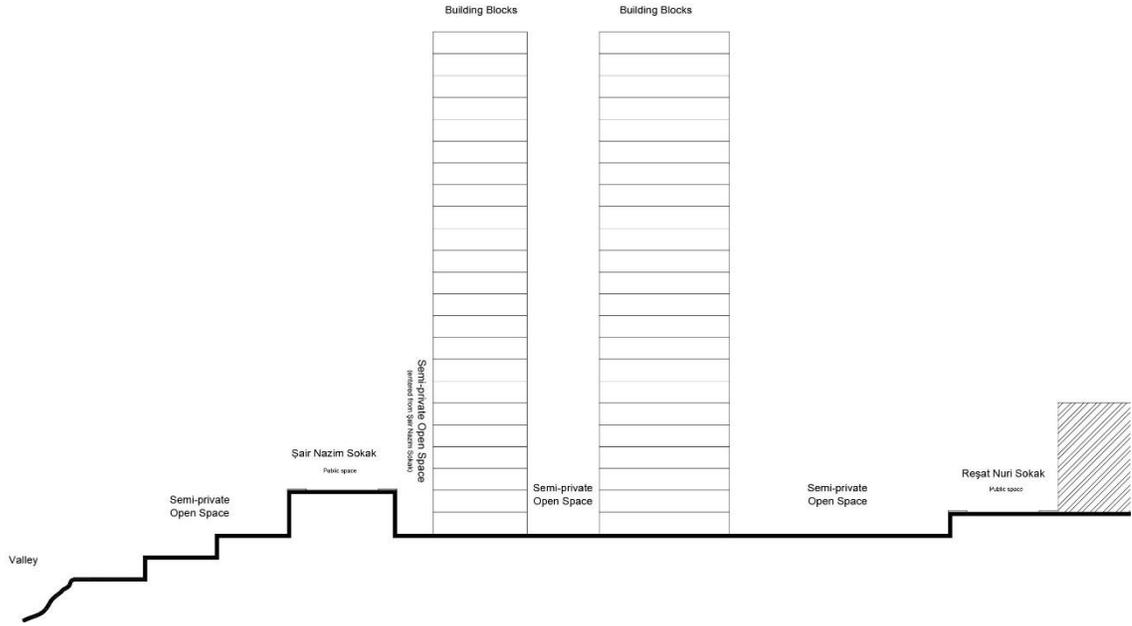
Typology 4-3, Çankaya Park Evleri 52 bloklar section drawing (source: author).
